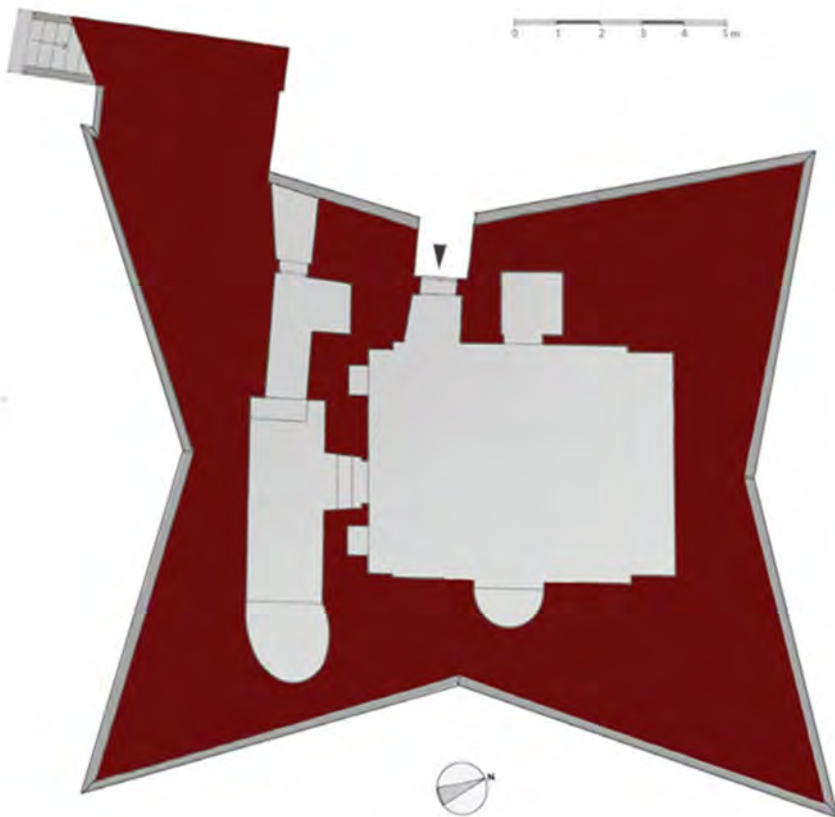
Torre di S. Pietro in Bevagna. Ipotesi della pianta del complesso nel XIX secolo (quota + m. 4,50).
